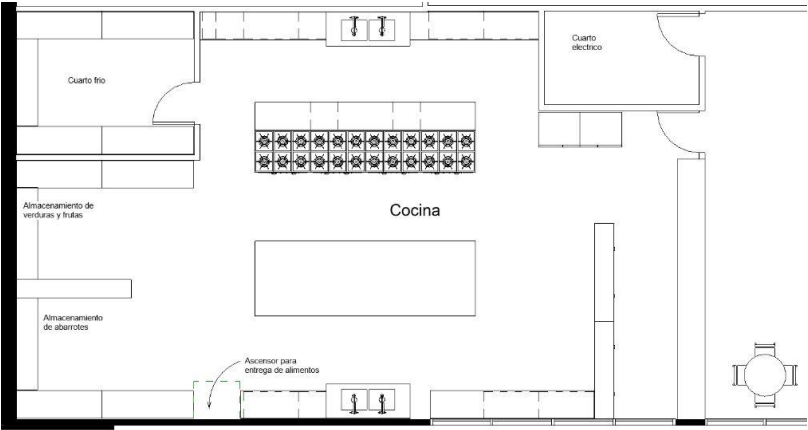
Detalle de la planta de la zona de comida. Fuente propia.
